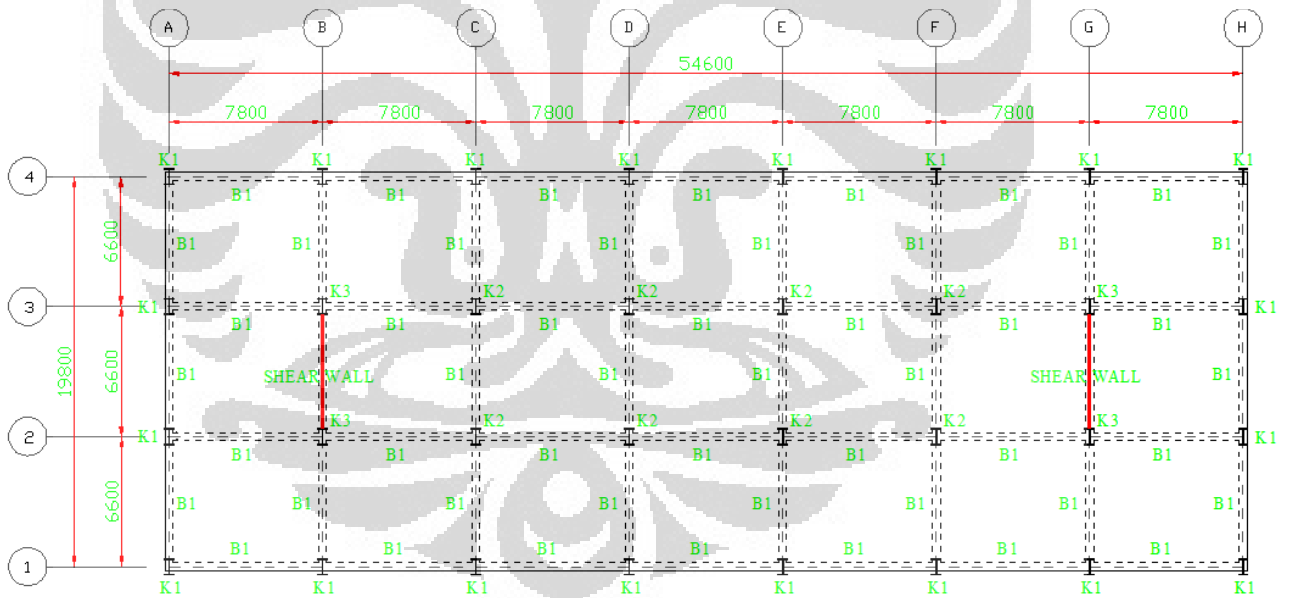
Denah Struktur Beton Lantai 5-8
